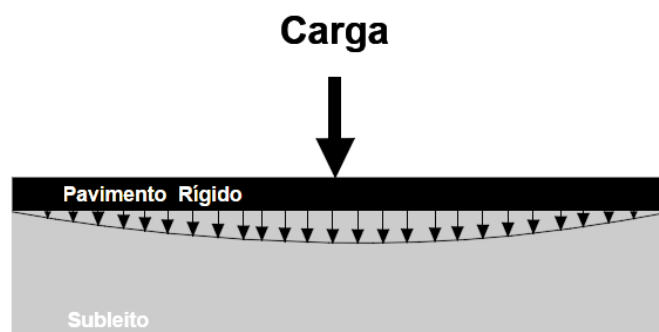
Representação da transmissão de cargas ao longo da estrutura de pavimento rígido (Fonte: autor, 2023).
